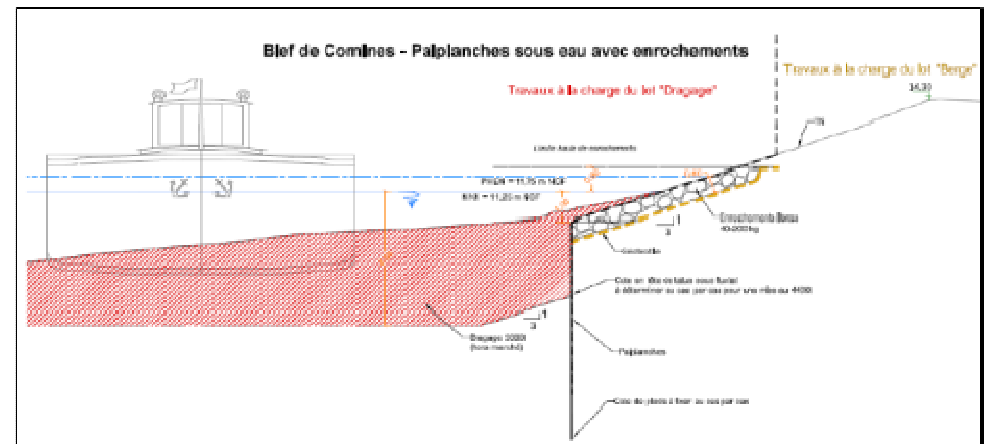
Schéma de principe d'un profil raidi avec palplanches
